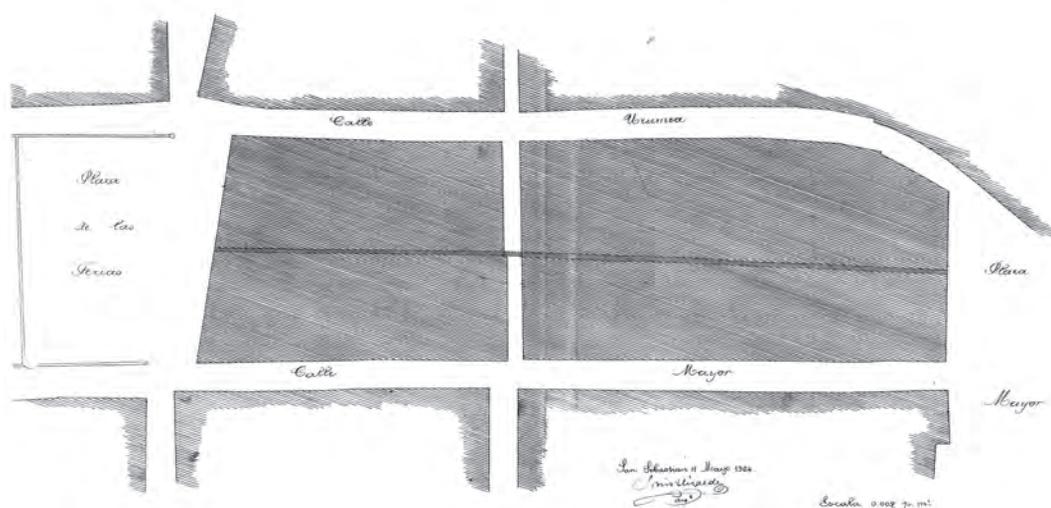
PLANO DE ALCANTARILLADO ENTRE LAS PLAZAS MAYOR Y DE LAS FERIAS SEGÚN PROYECTO DE 1904
